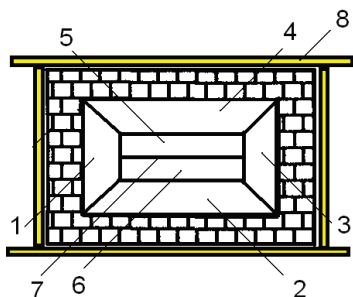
Схема предохранительной разрушающейся конструкции ограждения зданий.
